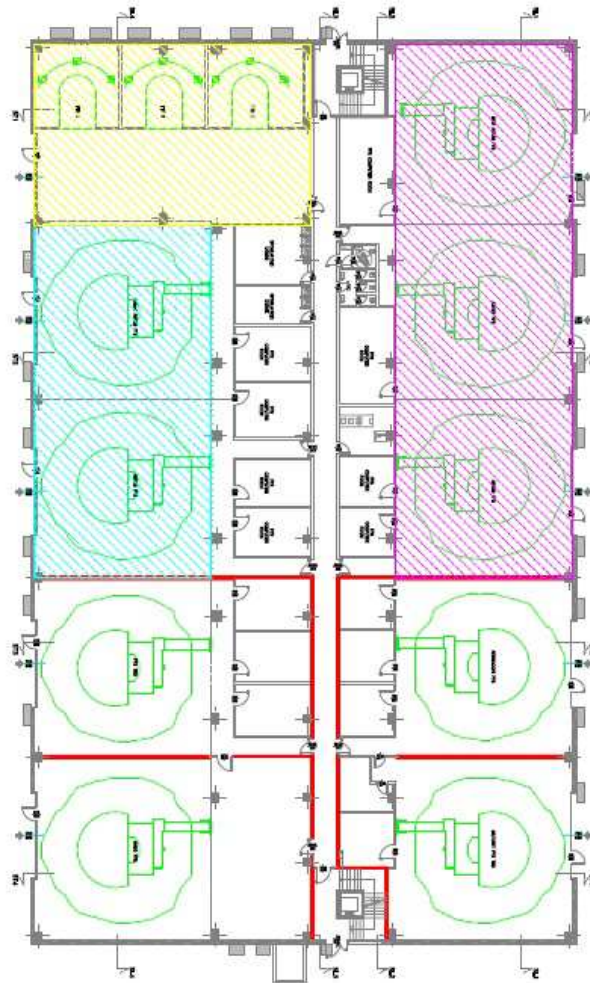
Pianta per identificare zone asservite dalle UTA.
